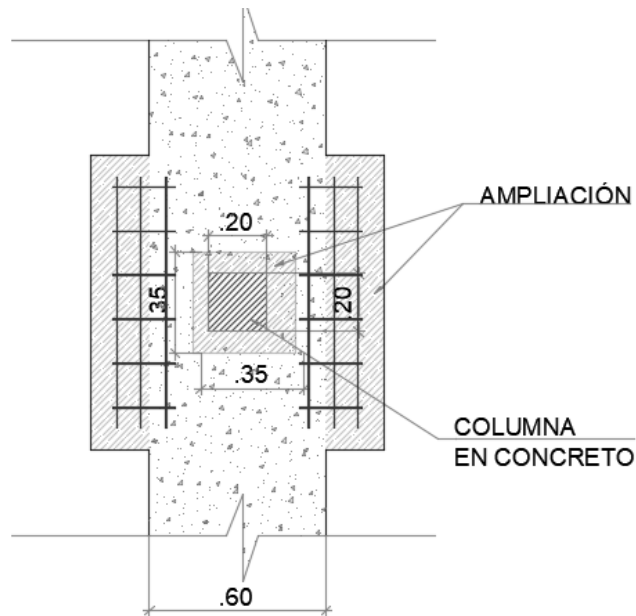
Alternativas de reforzamiento cimentación de columnas.
